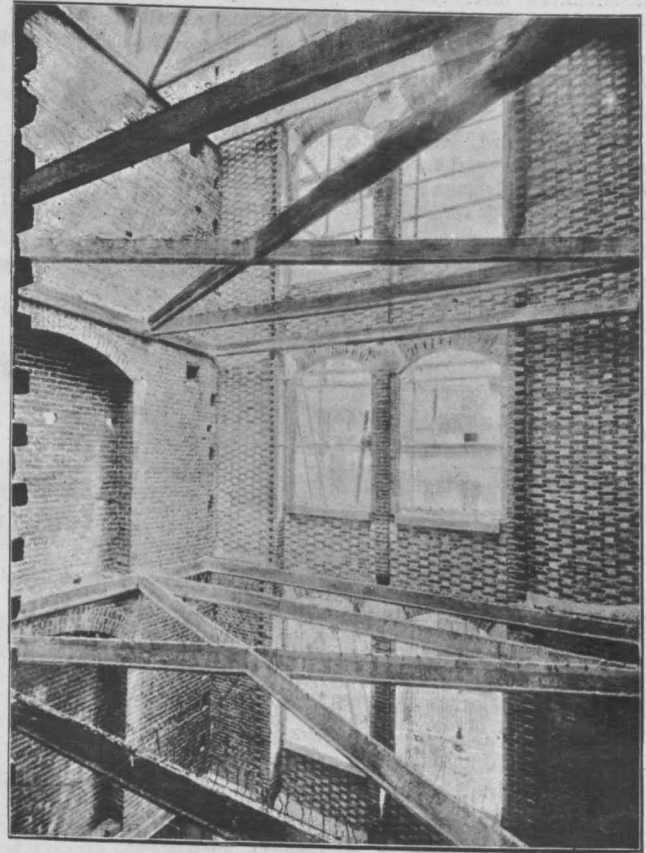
Deckenconstructionen nach System Cottançin. (Träger aus Béton mit Drahtgeflechtseinlage.)
